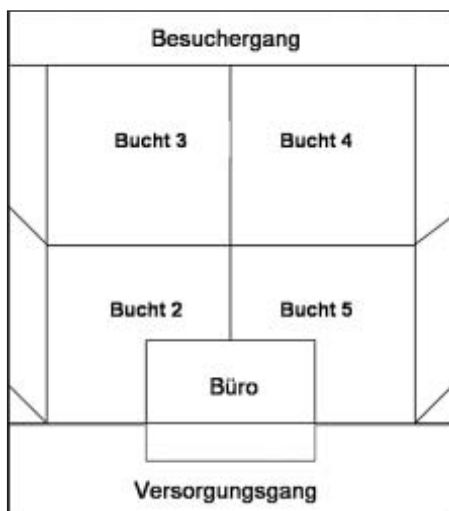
Grundriss des Versuchsstalls für Mast Schweine
